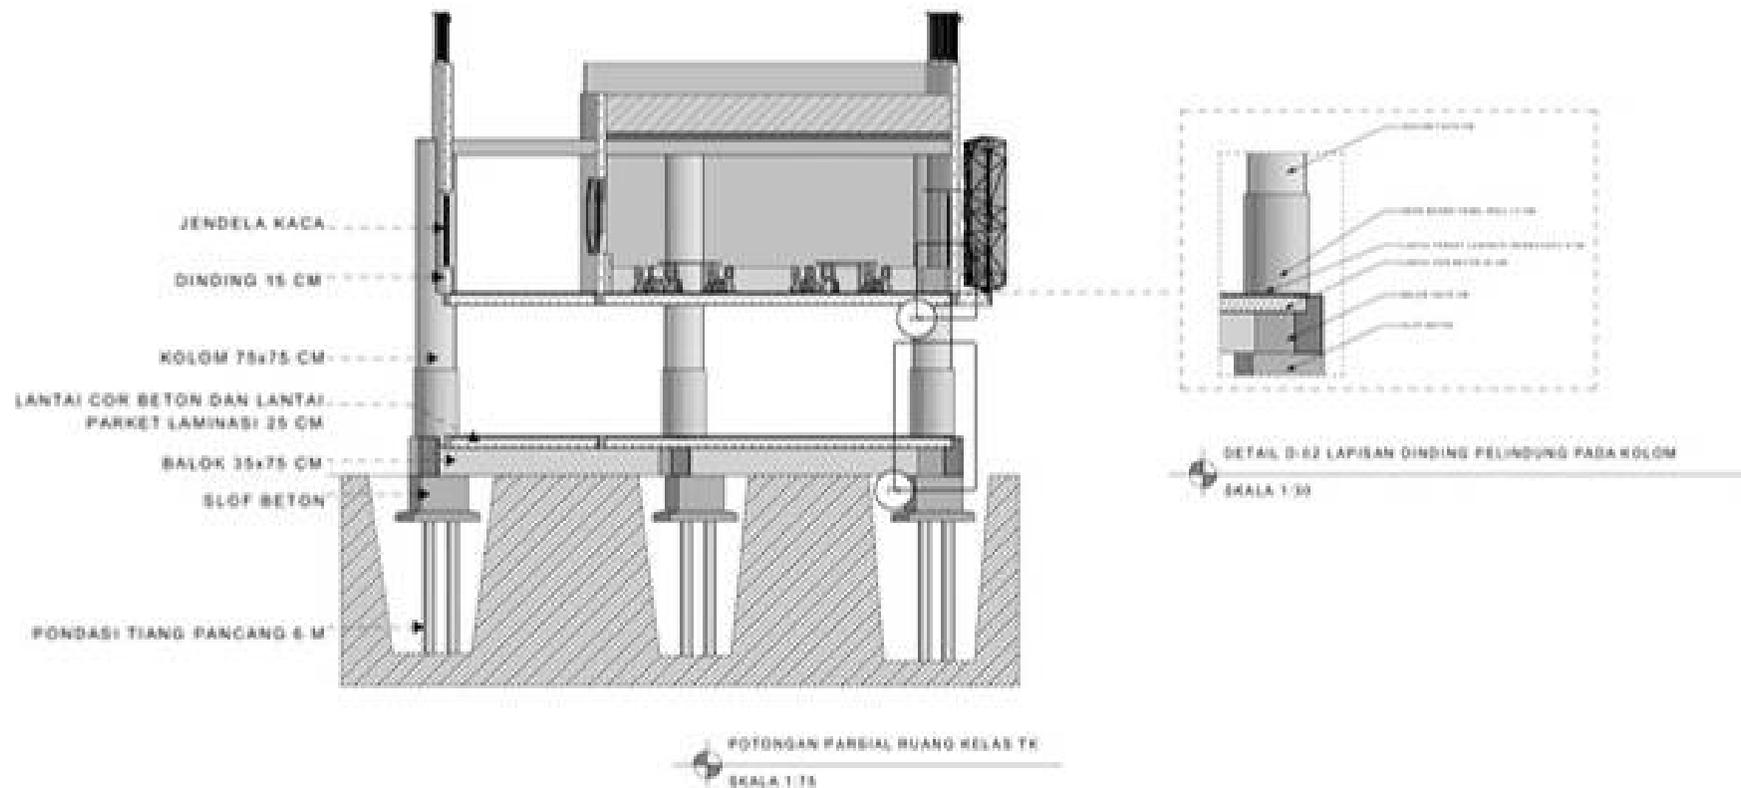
Potongan dan Detail Ruang Kelas TK
